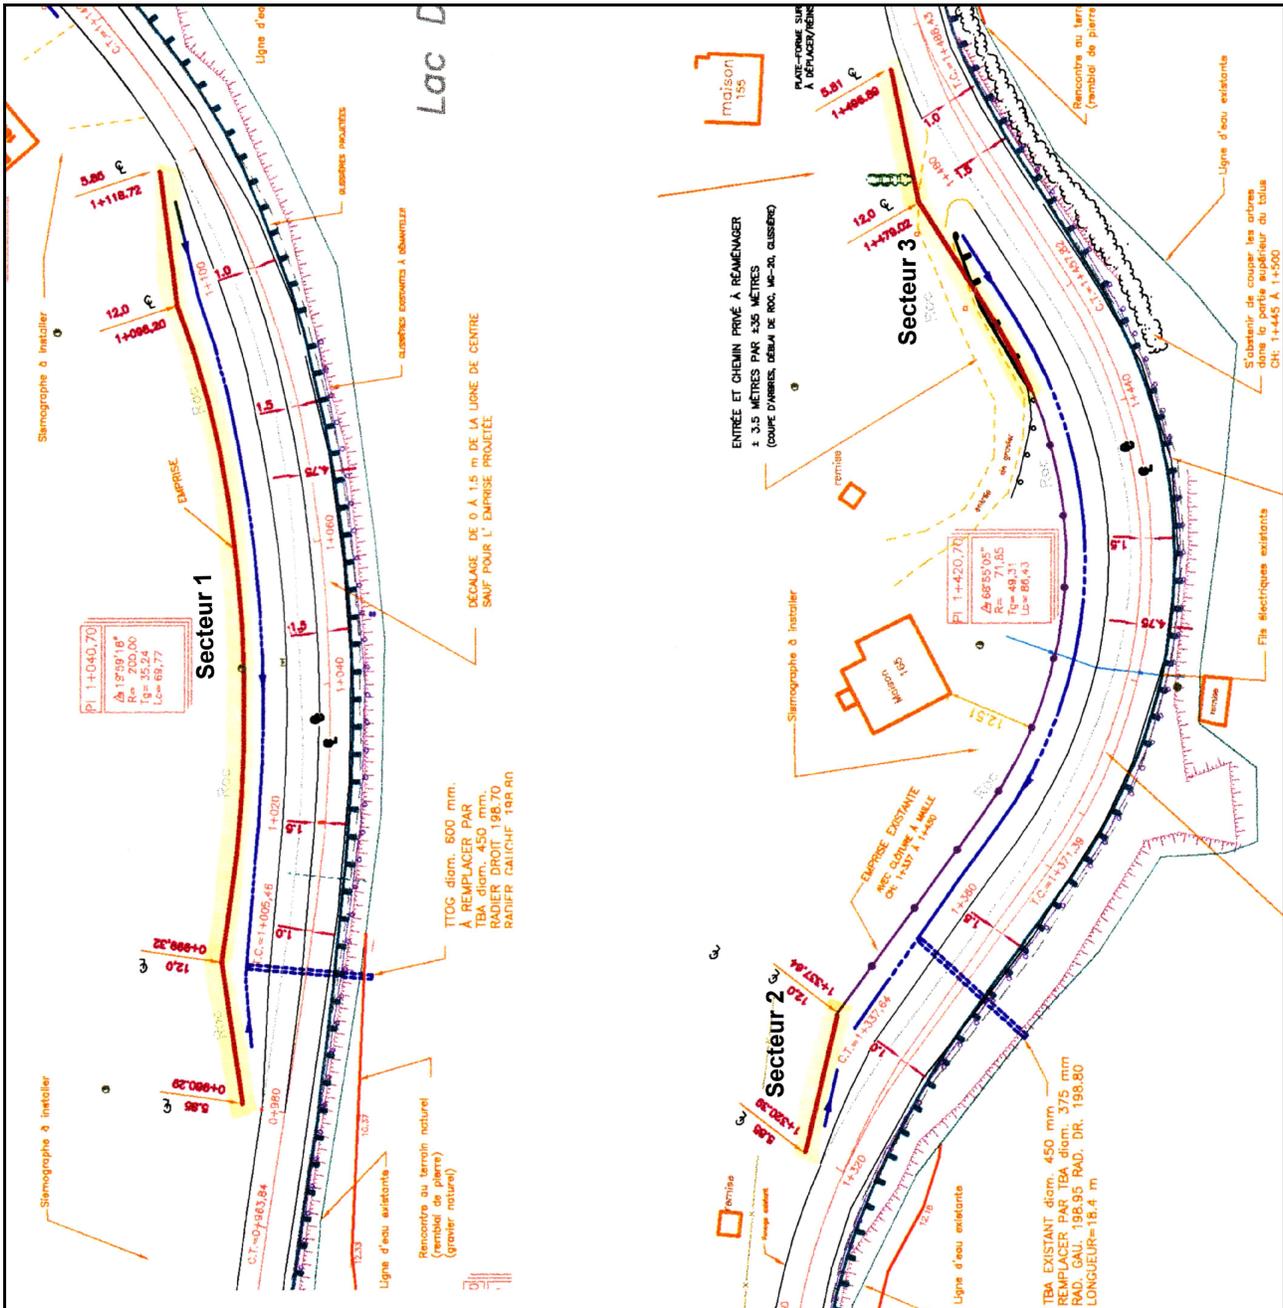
Localisation des secteurs d'inventaire sur le plan de construction du projet 20-5672-0146
